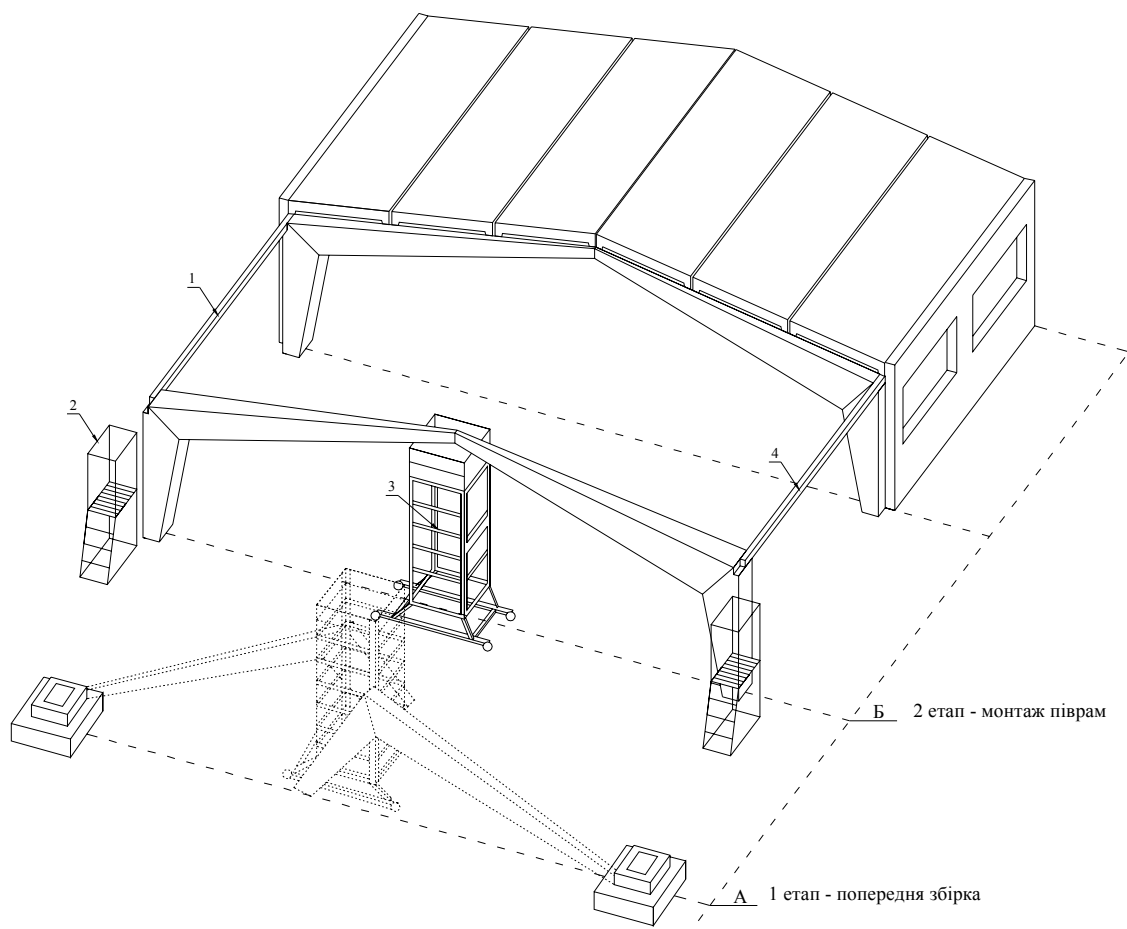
Схема укрупненої збірки і монтажу піврам:
